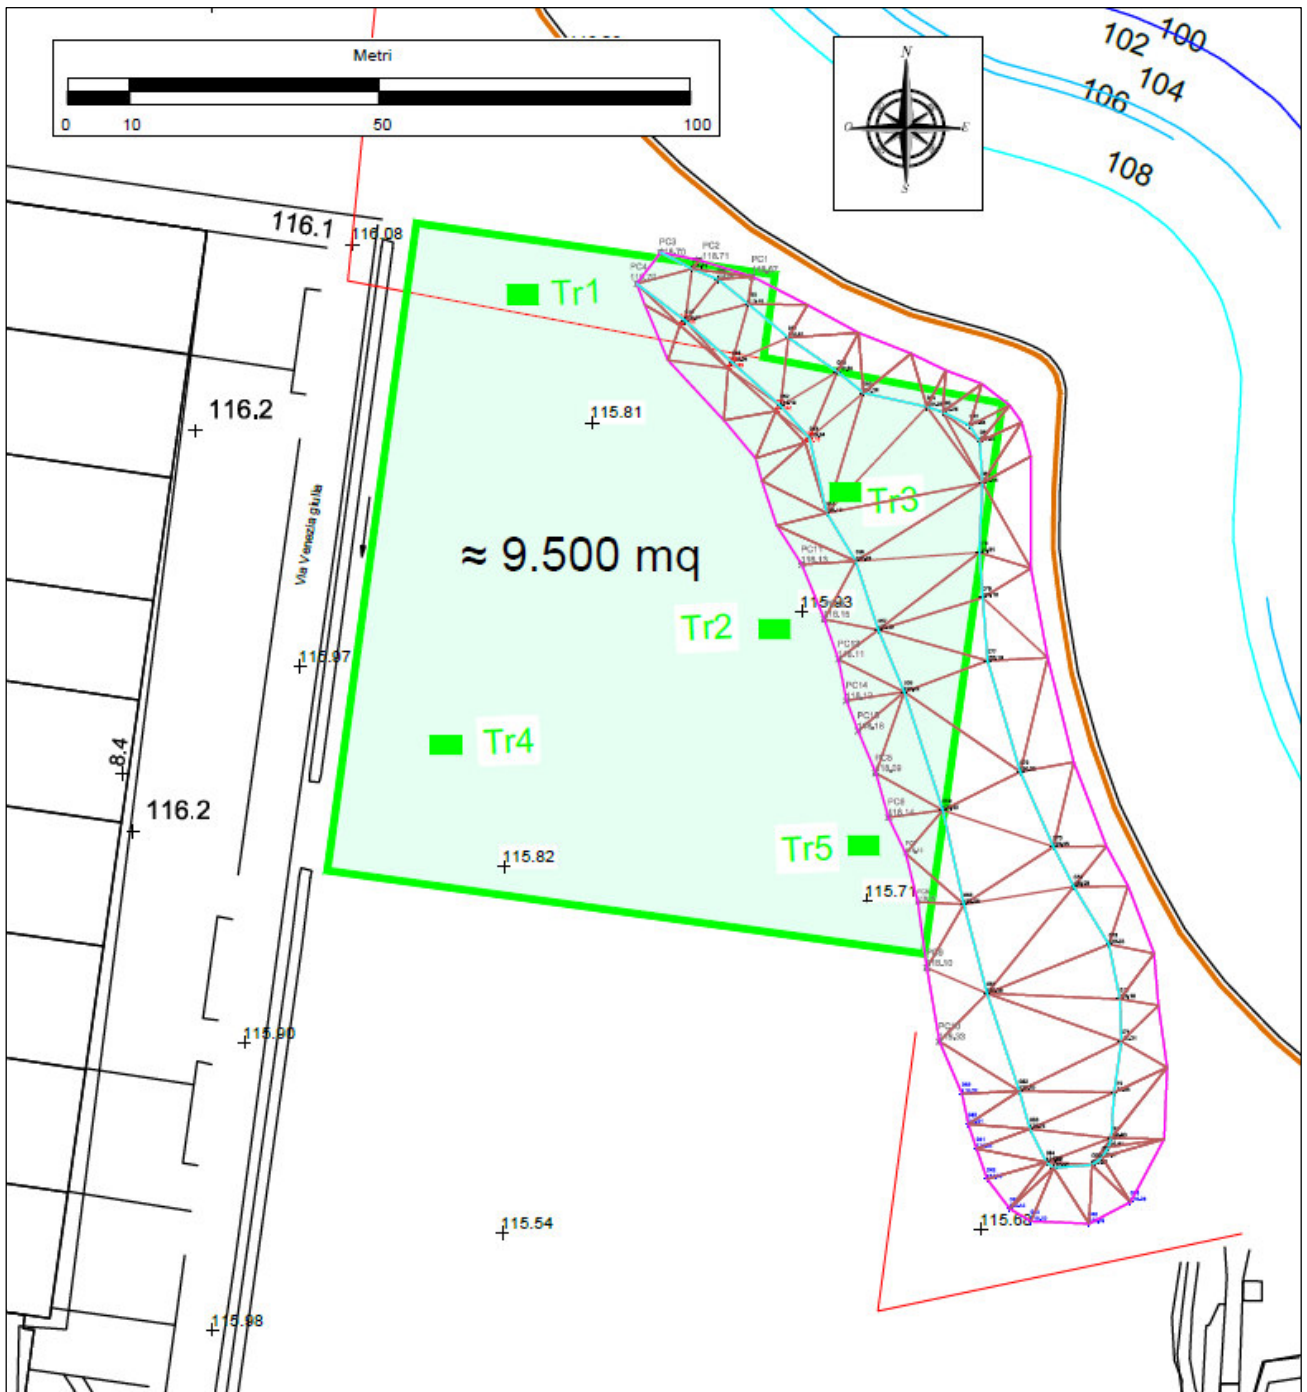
Planimetria area A2 con identificazione dei pozzetti
